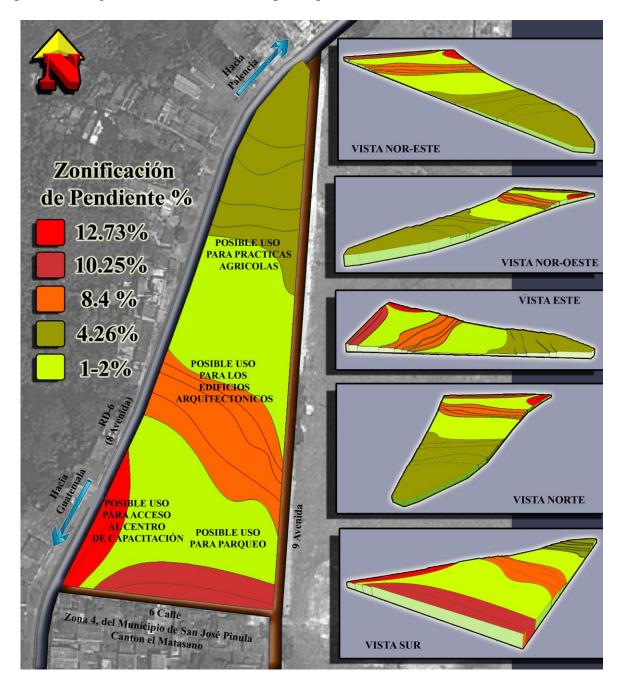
Plano Topográfico del Terreno a intervenir. Fuente: Dibujo de Jerónimo Reyes
